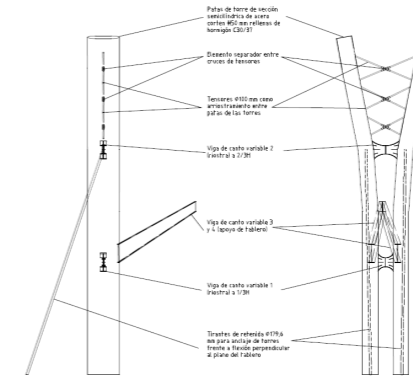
Definición de los elementos estructurales de las torres. Fuente: Elaboración Propia (AutoCAD)
